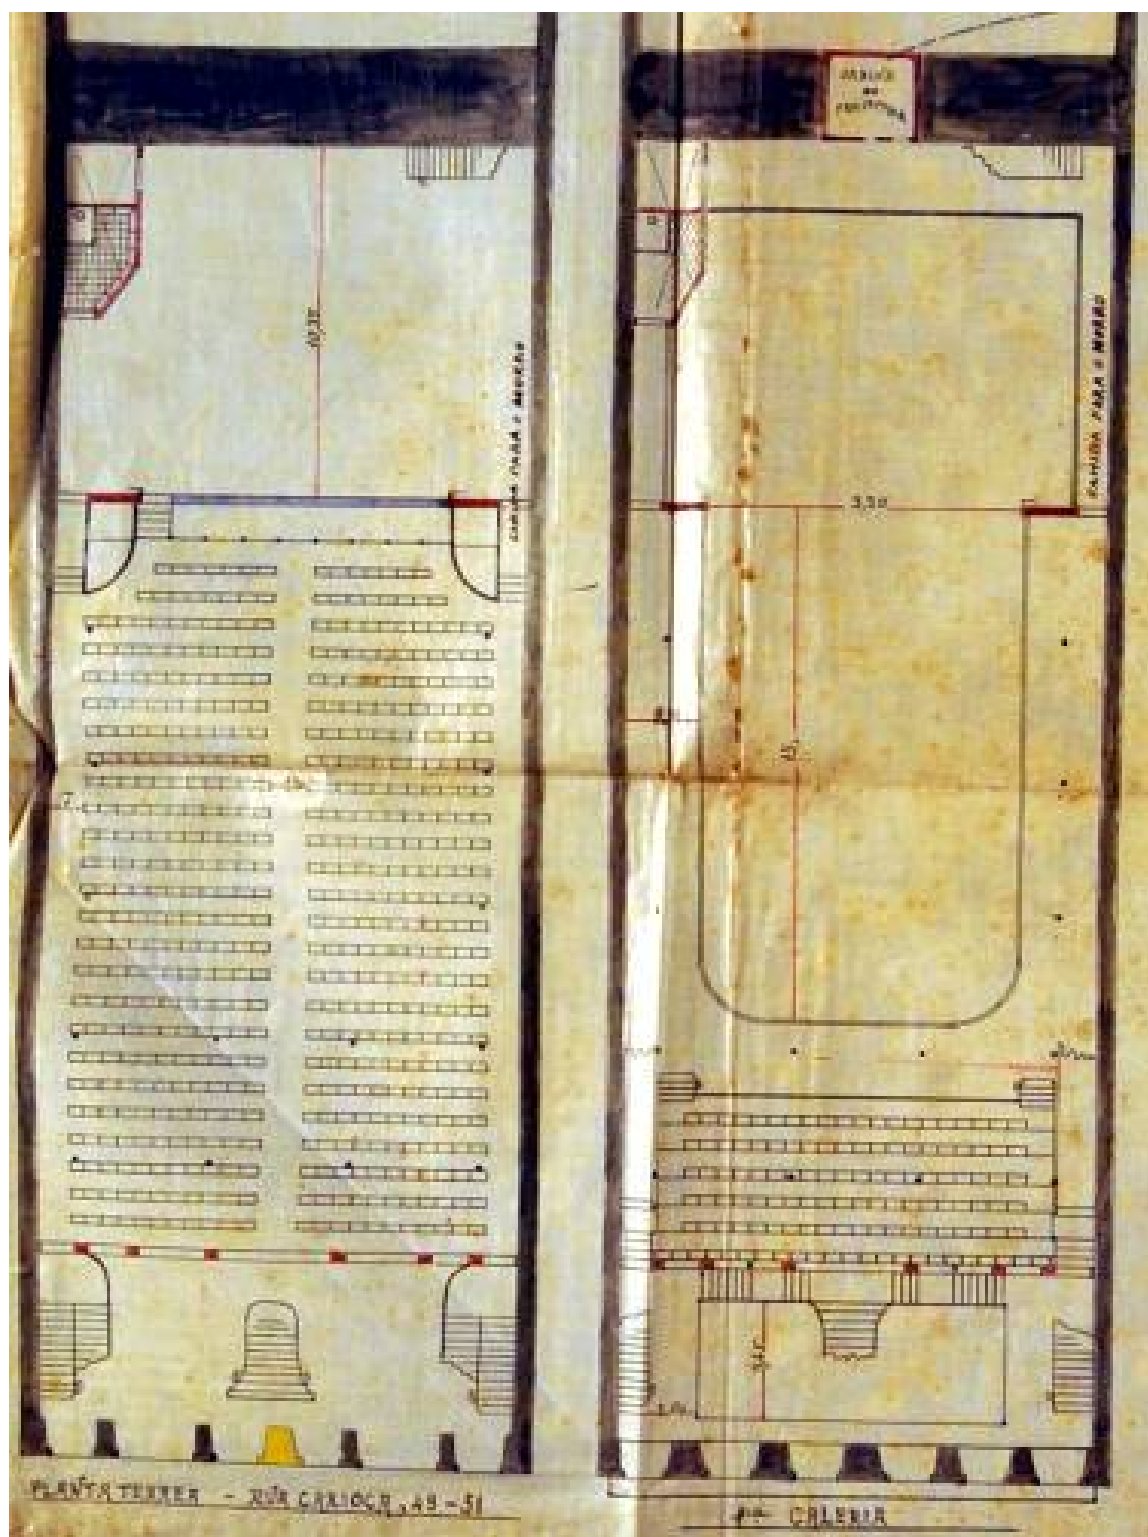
Planta de modificação do pavimento térreo do Cinema Íris (1920). Fonte: AGCRJ.
